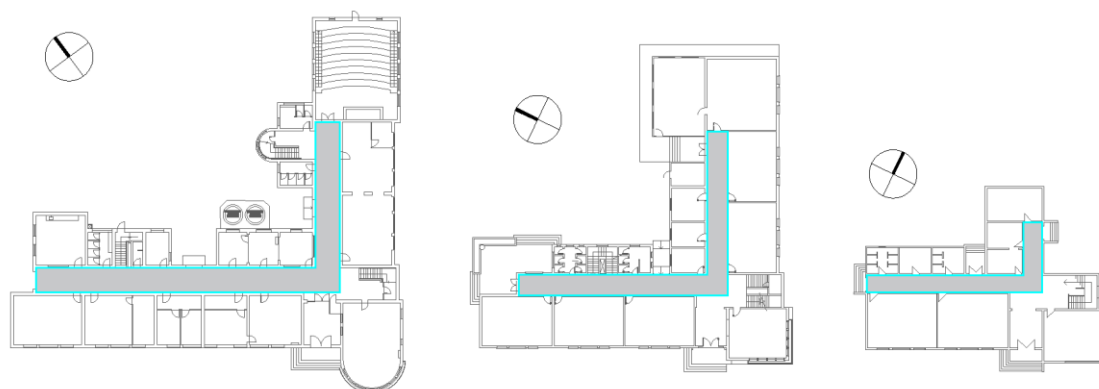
Planta baixa do 1º pavimento dos Colégios Assis Brasil, Joaquim Caetano e Marques de Souza, demarcação das circulações.
